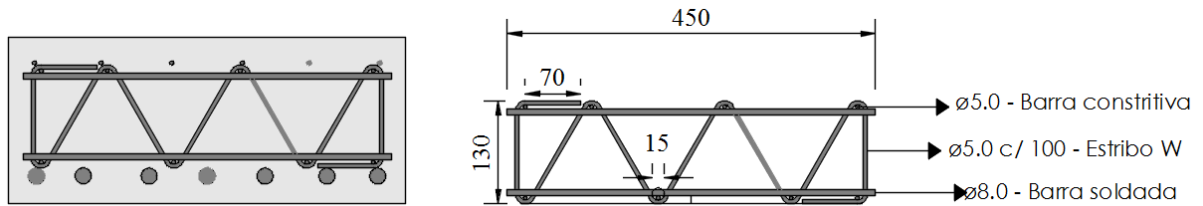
Vista lateral e seção transversal da viga S-3.4-0.24
